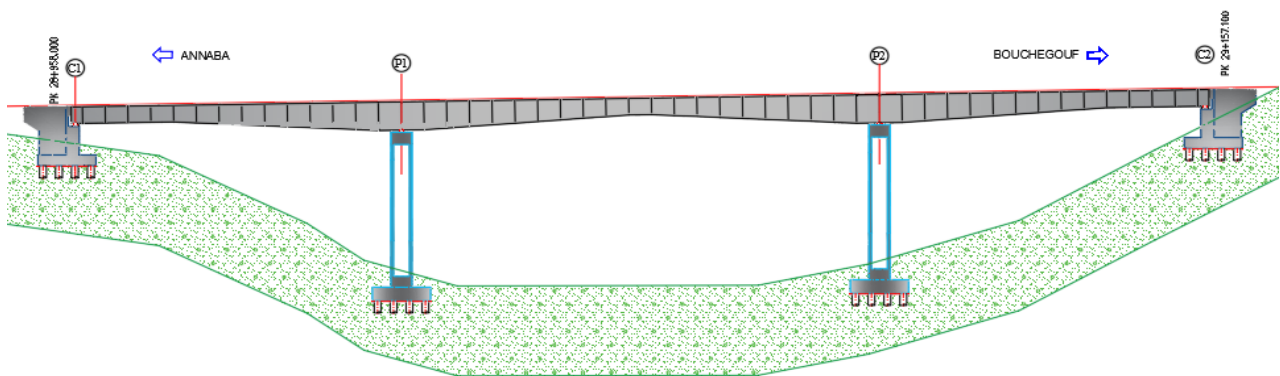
schéma de la variante pont voussoir en béton précontraint construit par encorbellements successifs
